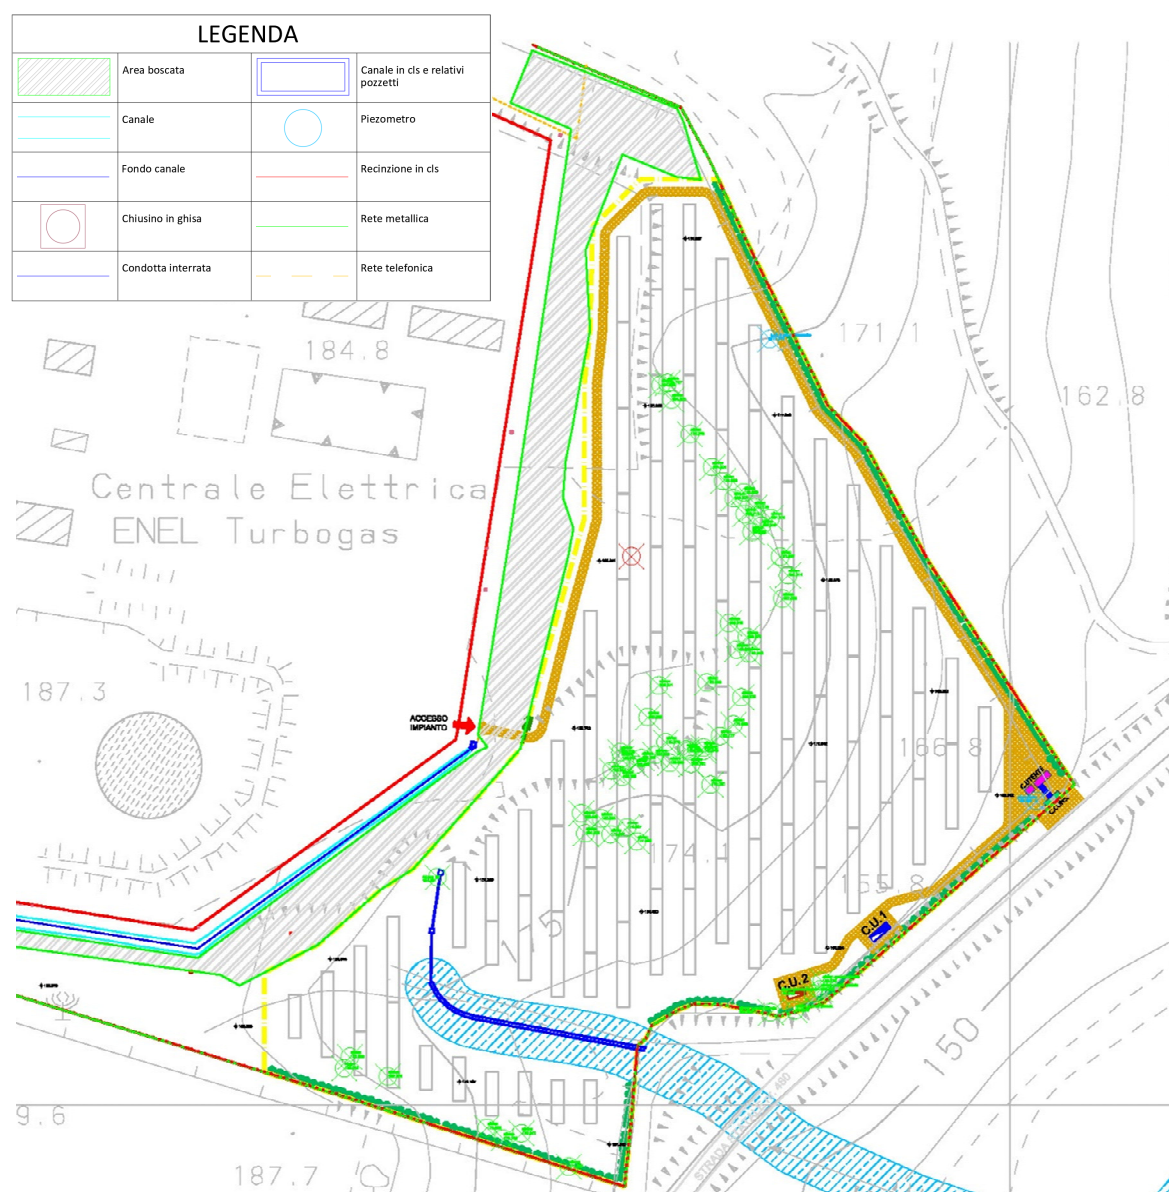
Planimetria delle interferenze – impianto Larino 2 (cfr. planimetria interferenze allegata al progetto)
